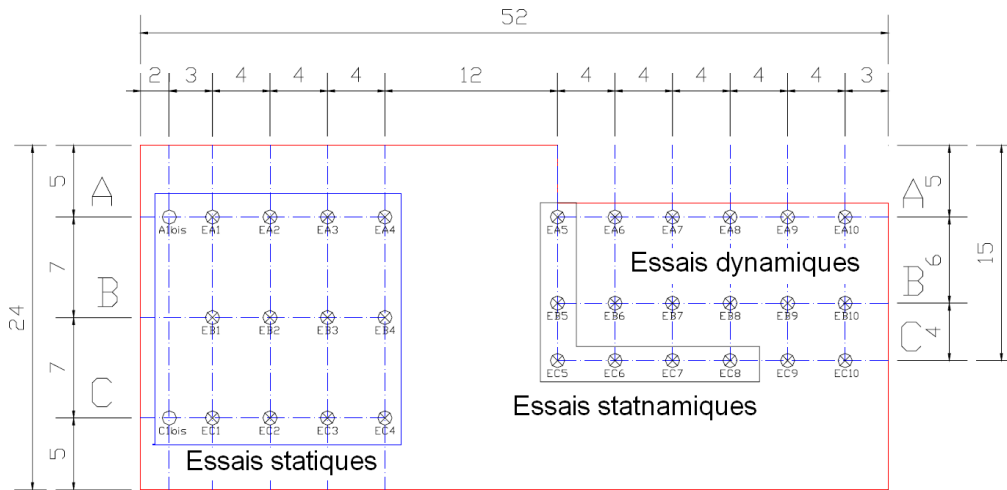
Plan de la zone pieux dans le site de Limelette
